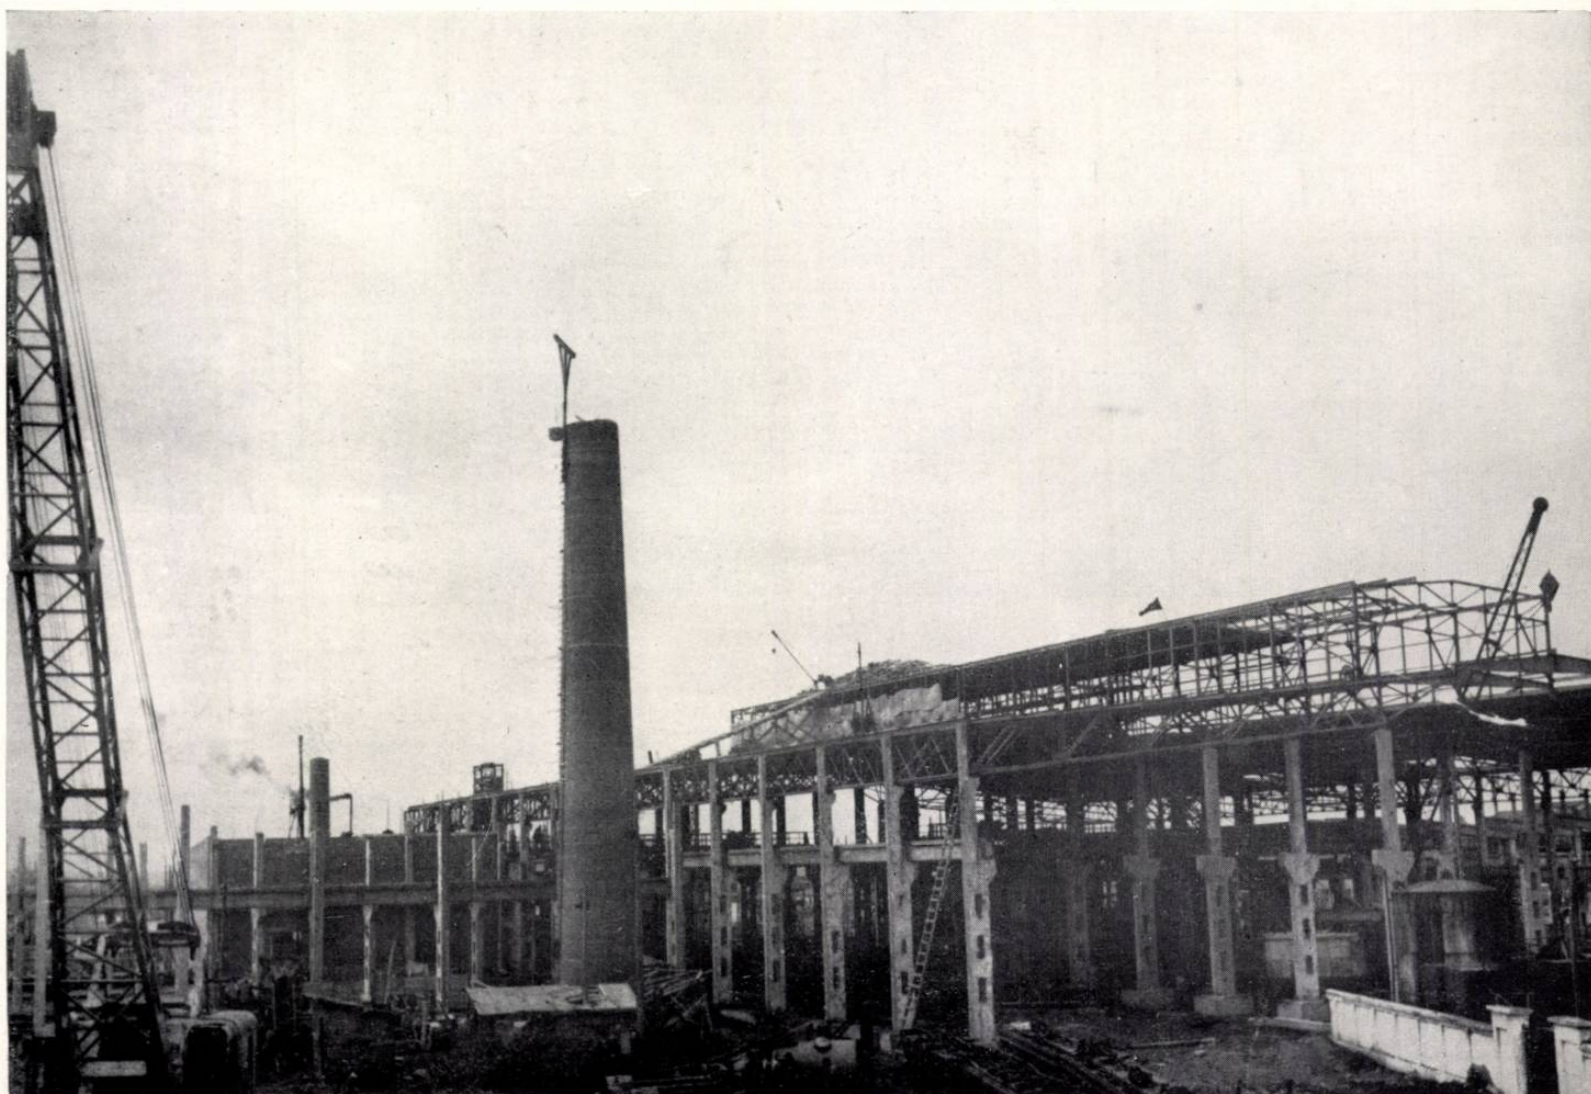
Hală de fabricație — Fațadă frontală. Stilpi, ferestre, plăci pentru pereți și plăci pentru acoperiș prefabricate din beton armat.
